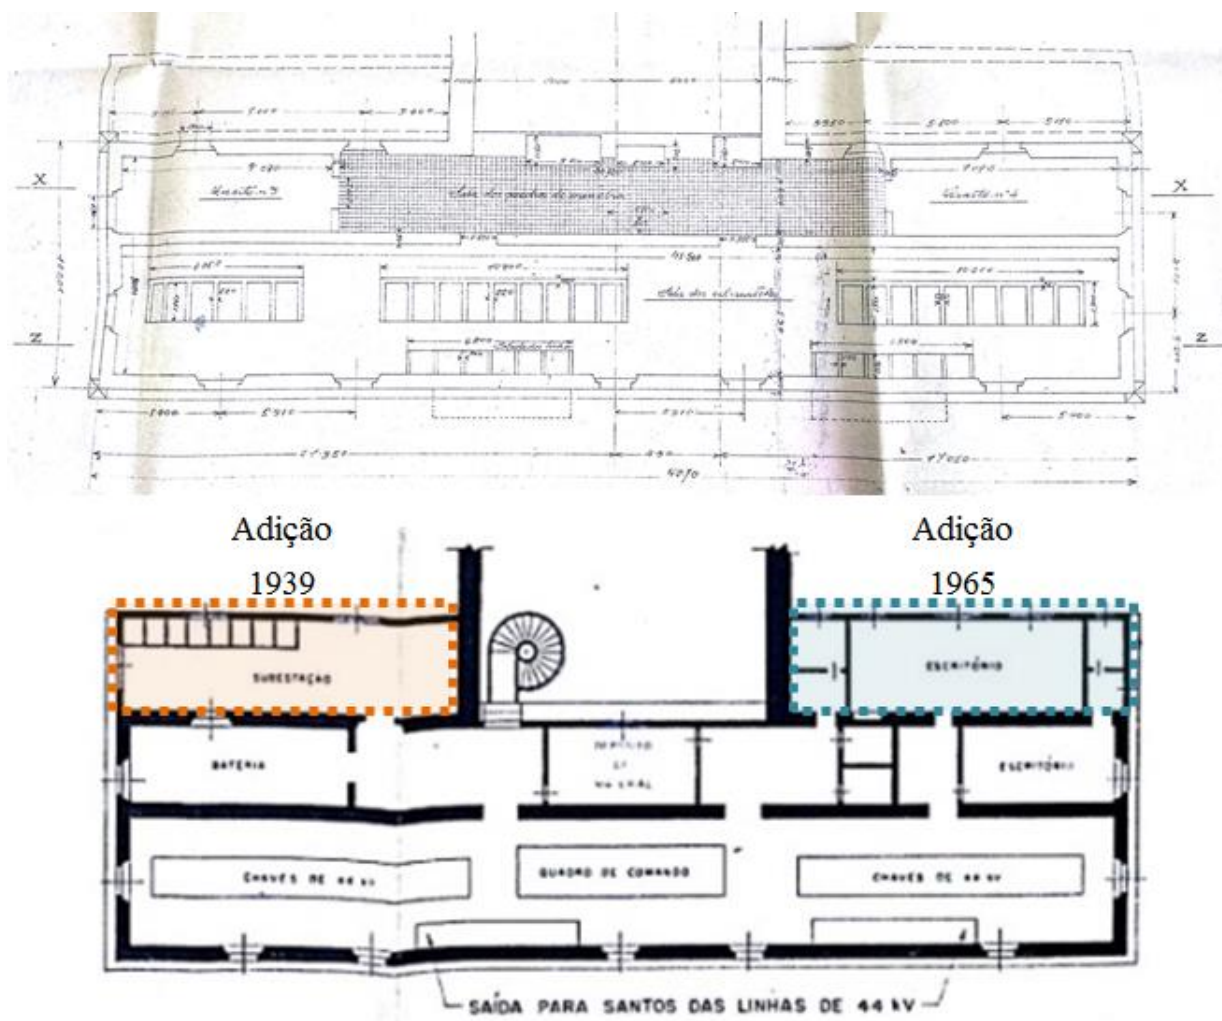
Pavimento superior. Acima: Trecho da planta Casa da Força, CDS, 1912 (cópia). Abaixo: Trecho da planta Casa da Força, Codesp, 1983.
